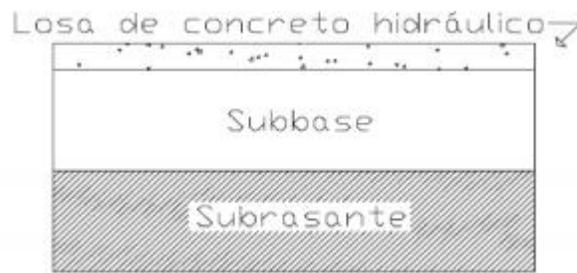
Capas de una estructura de pavimento con concreto hidráulico.
